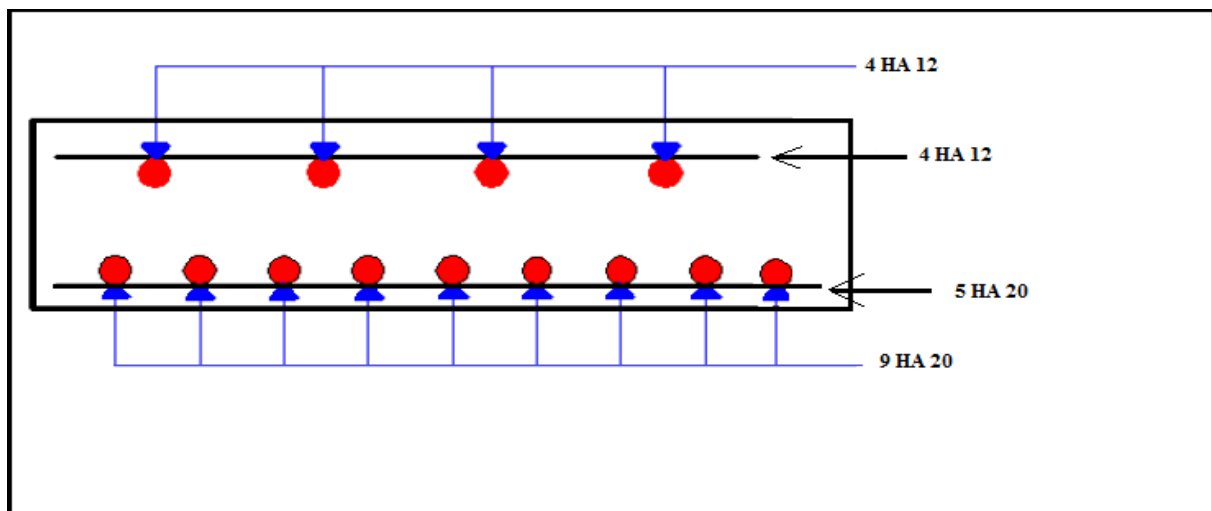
Ferrailage dans le sens Longitudinal (coupeA-A)
